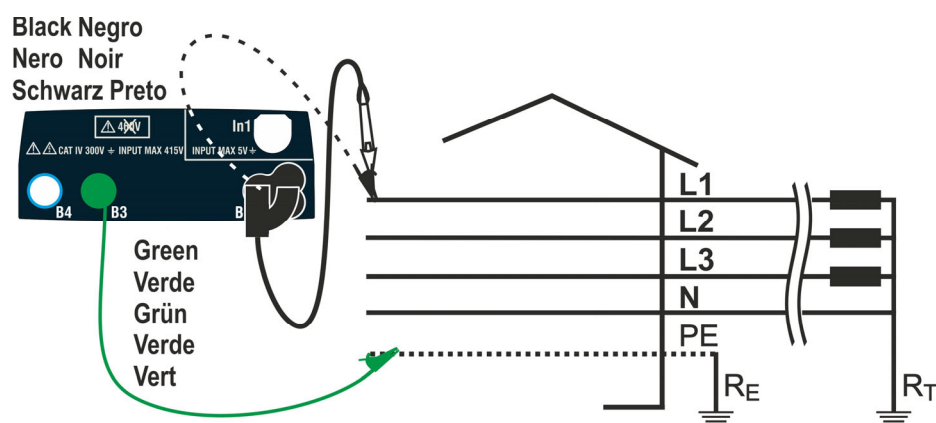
Teste L1-PE de 2 fios para sistemas Trifásicos com cabos e condutor remoto
